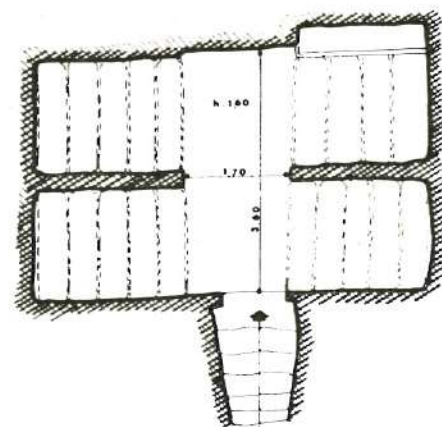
SCOPPA: planimetria dell'ipogeo n. 1.
